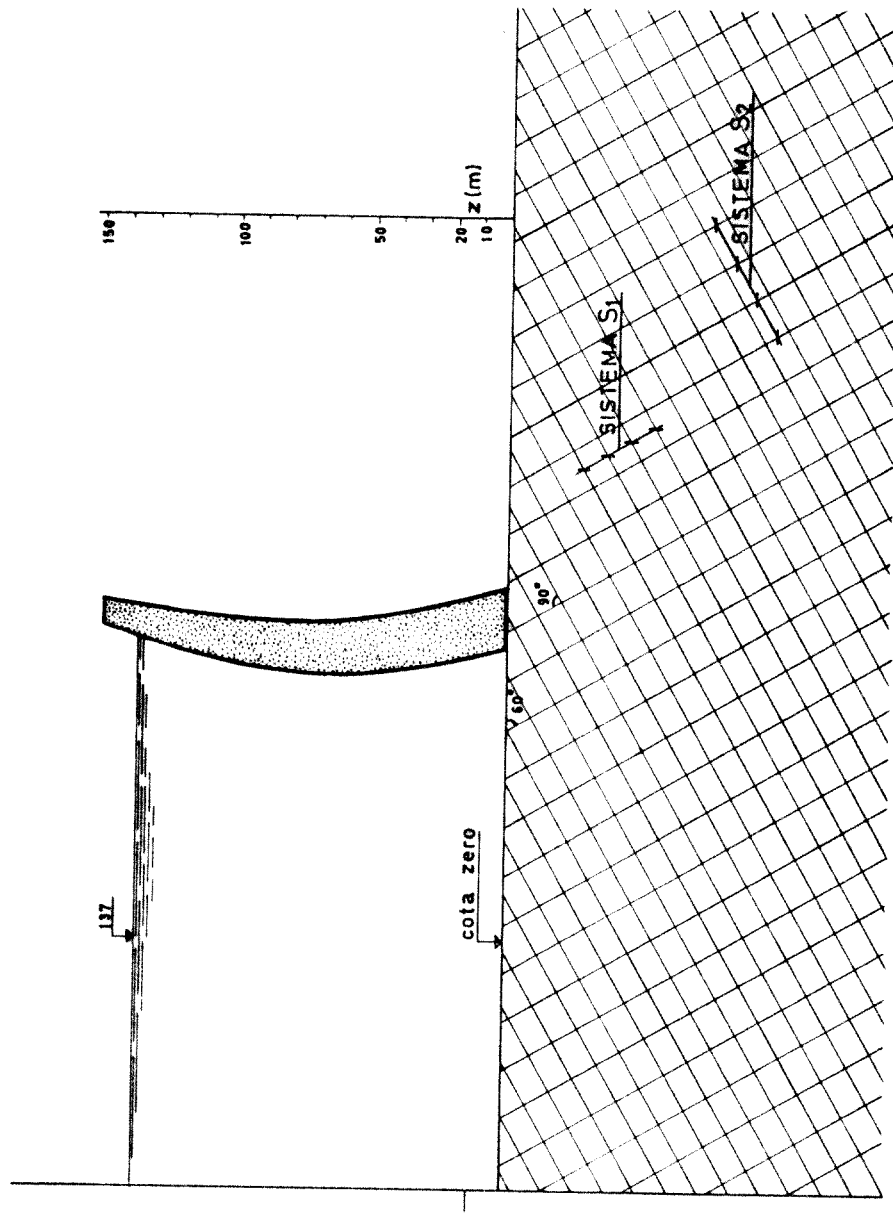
Maciço rochoso fissurado da zona de fundação de uma barragem em cupula.
